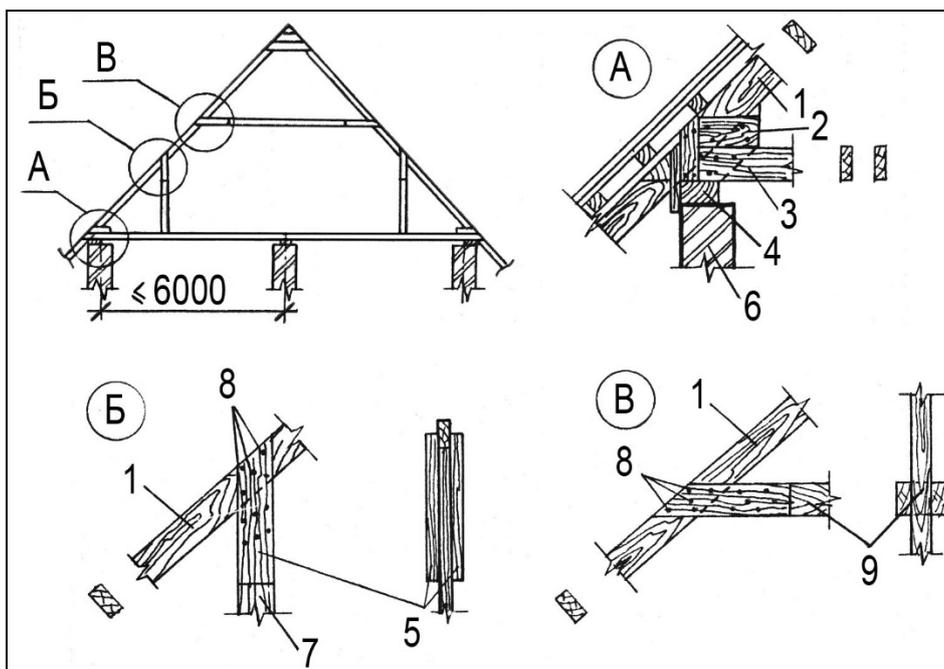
Стропила из досок в случае небольшого дома с мансардой; 1 – стропильная нога (верхний пояс фермы), 2 – вставка, 3 – несущая конструкция чердачного перекрытия (нижний пояс фермы), 4 – мауэрлат, 5 – накладка, 6 – наружная стена, 7 – стойка, 8 – гвозди, 9 – ригель
